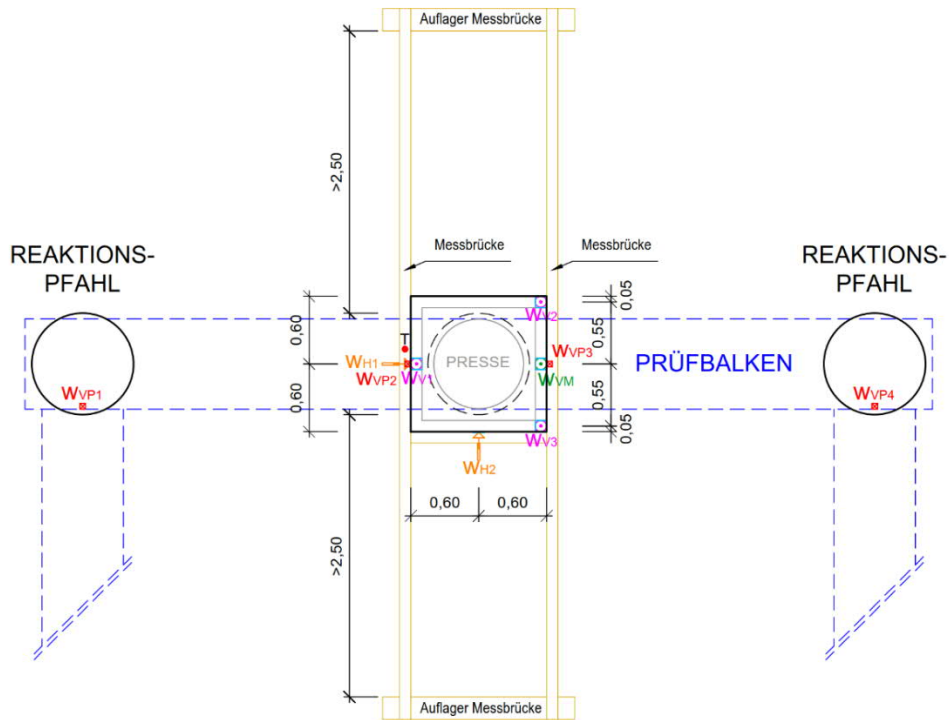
Instrumentierung Pfahlkopf Großbohrpfähle Grundriss, Planausschnitt aus [92]
